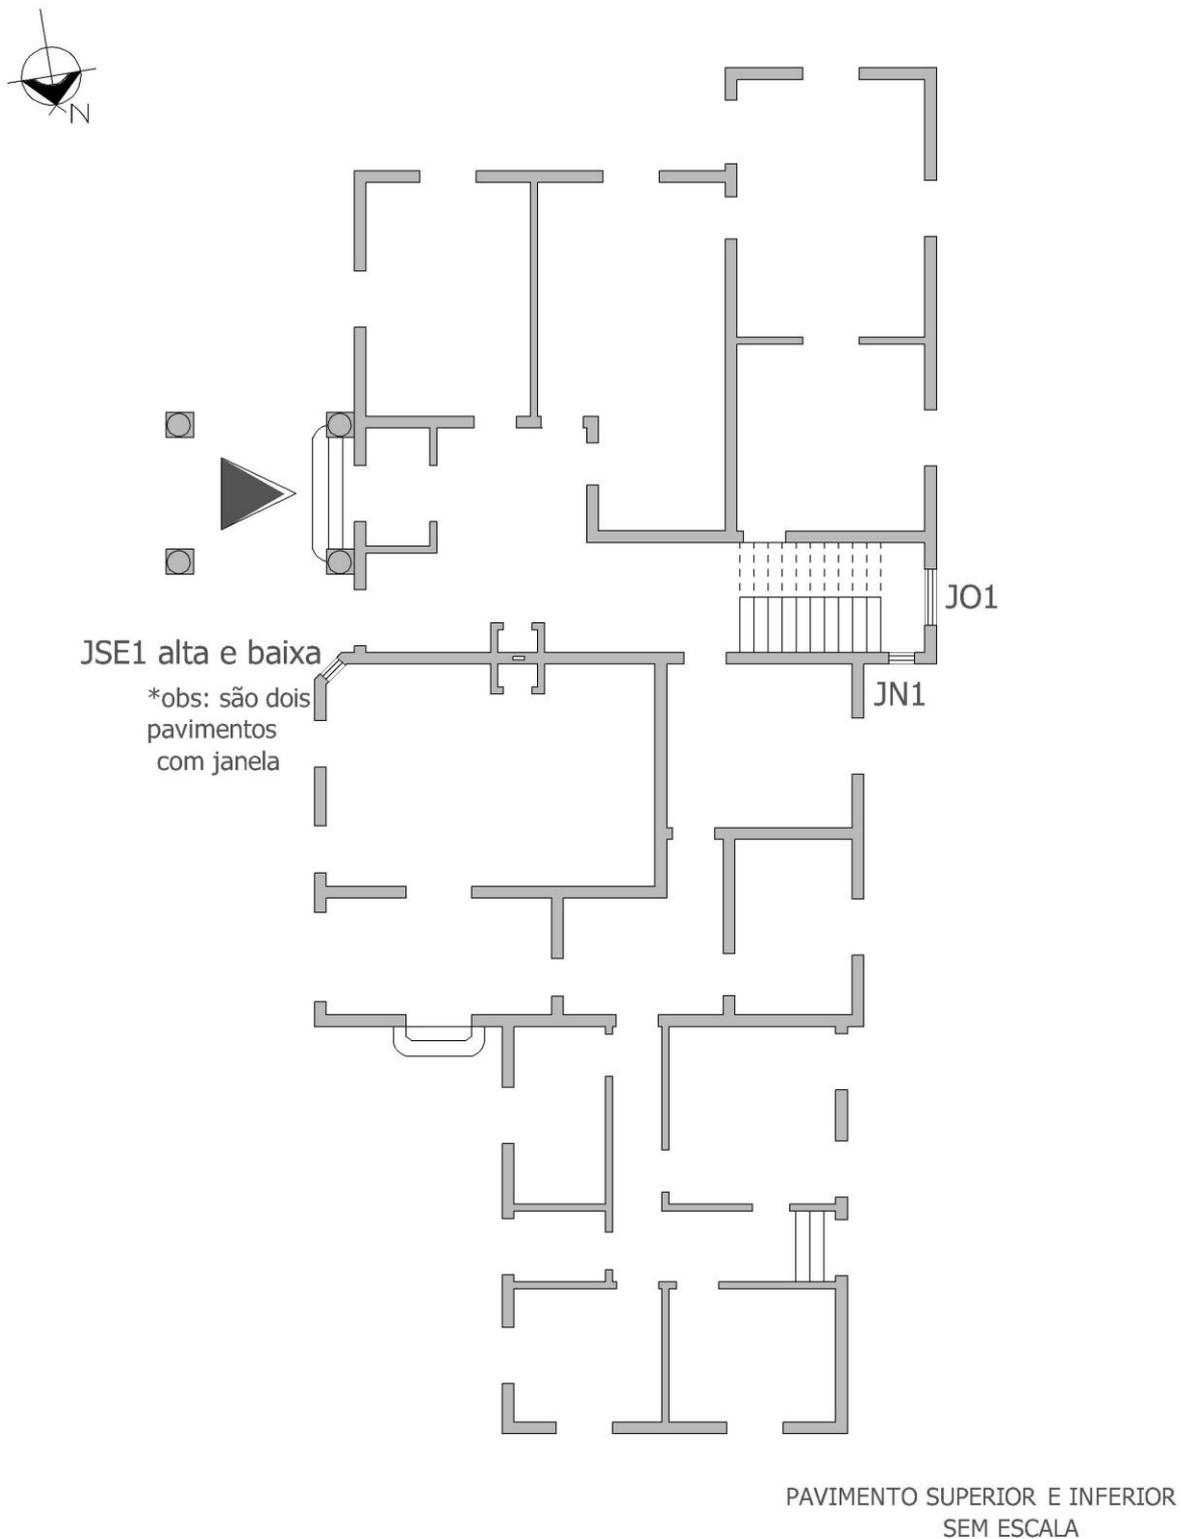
Planta de localização do conjunto de vitrais da Vila Santa Eulália.
